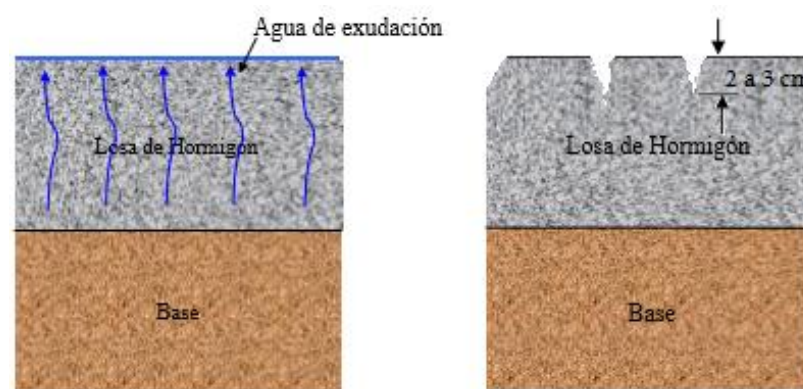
“Fisuras debido a Retracción plástica”. Fuente: (Halvorsen and Poston, 1993).
